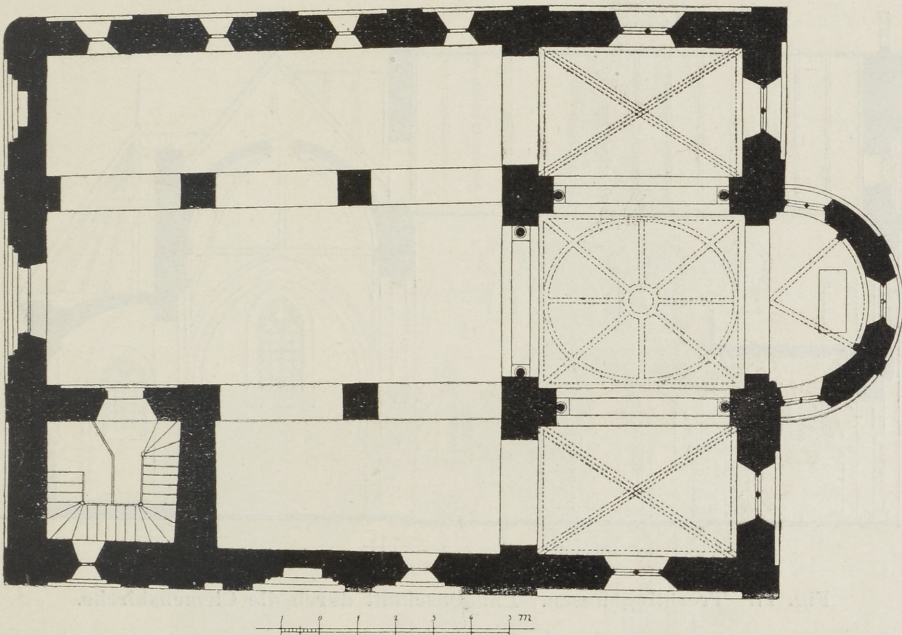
Trechtinghausen. Grundriss der Clemenskirche.
